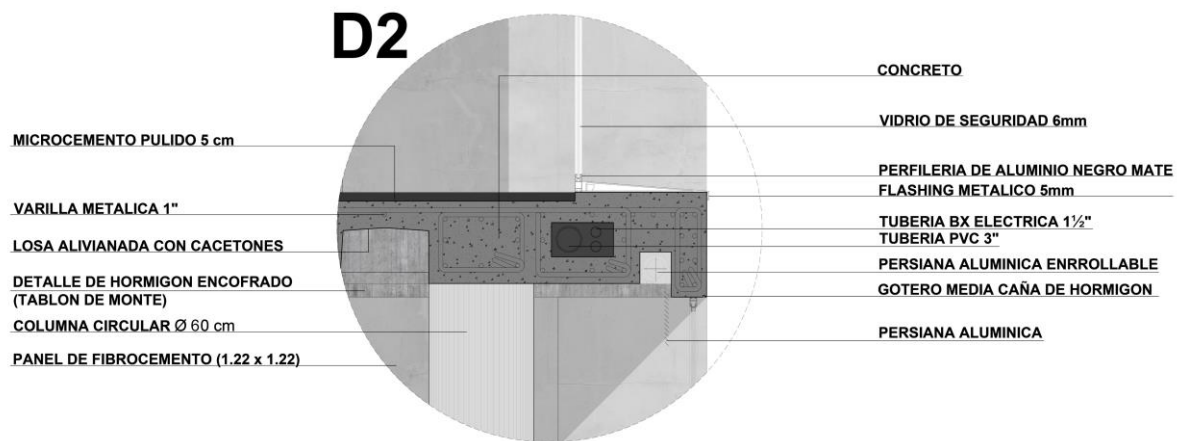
Detalle 2. Corte por fachada 1. Elaboración propia.
